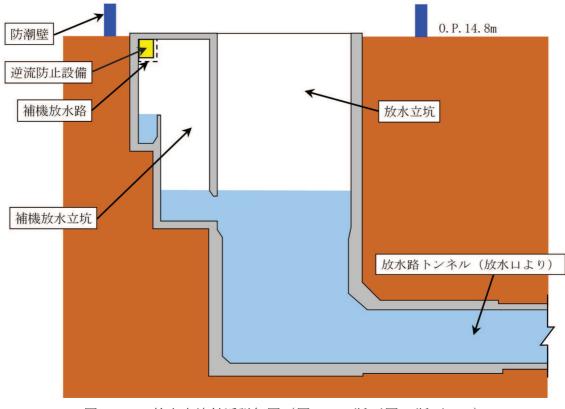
放水立坑付近詳細図 (図 4-3-1 断面図:断面 A-A)
